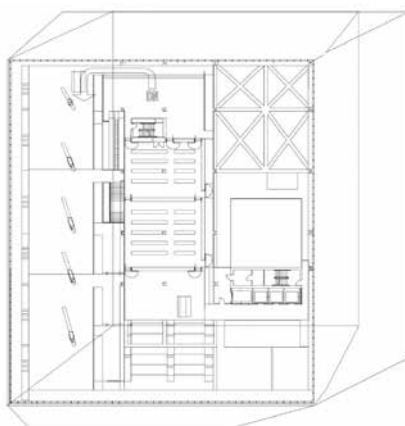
Planta de Piso 10 - Sala de Leitura.
